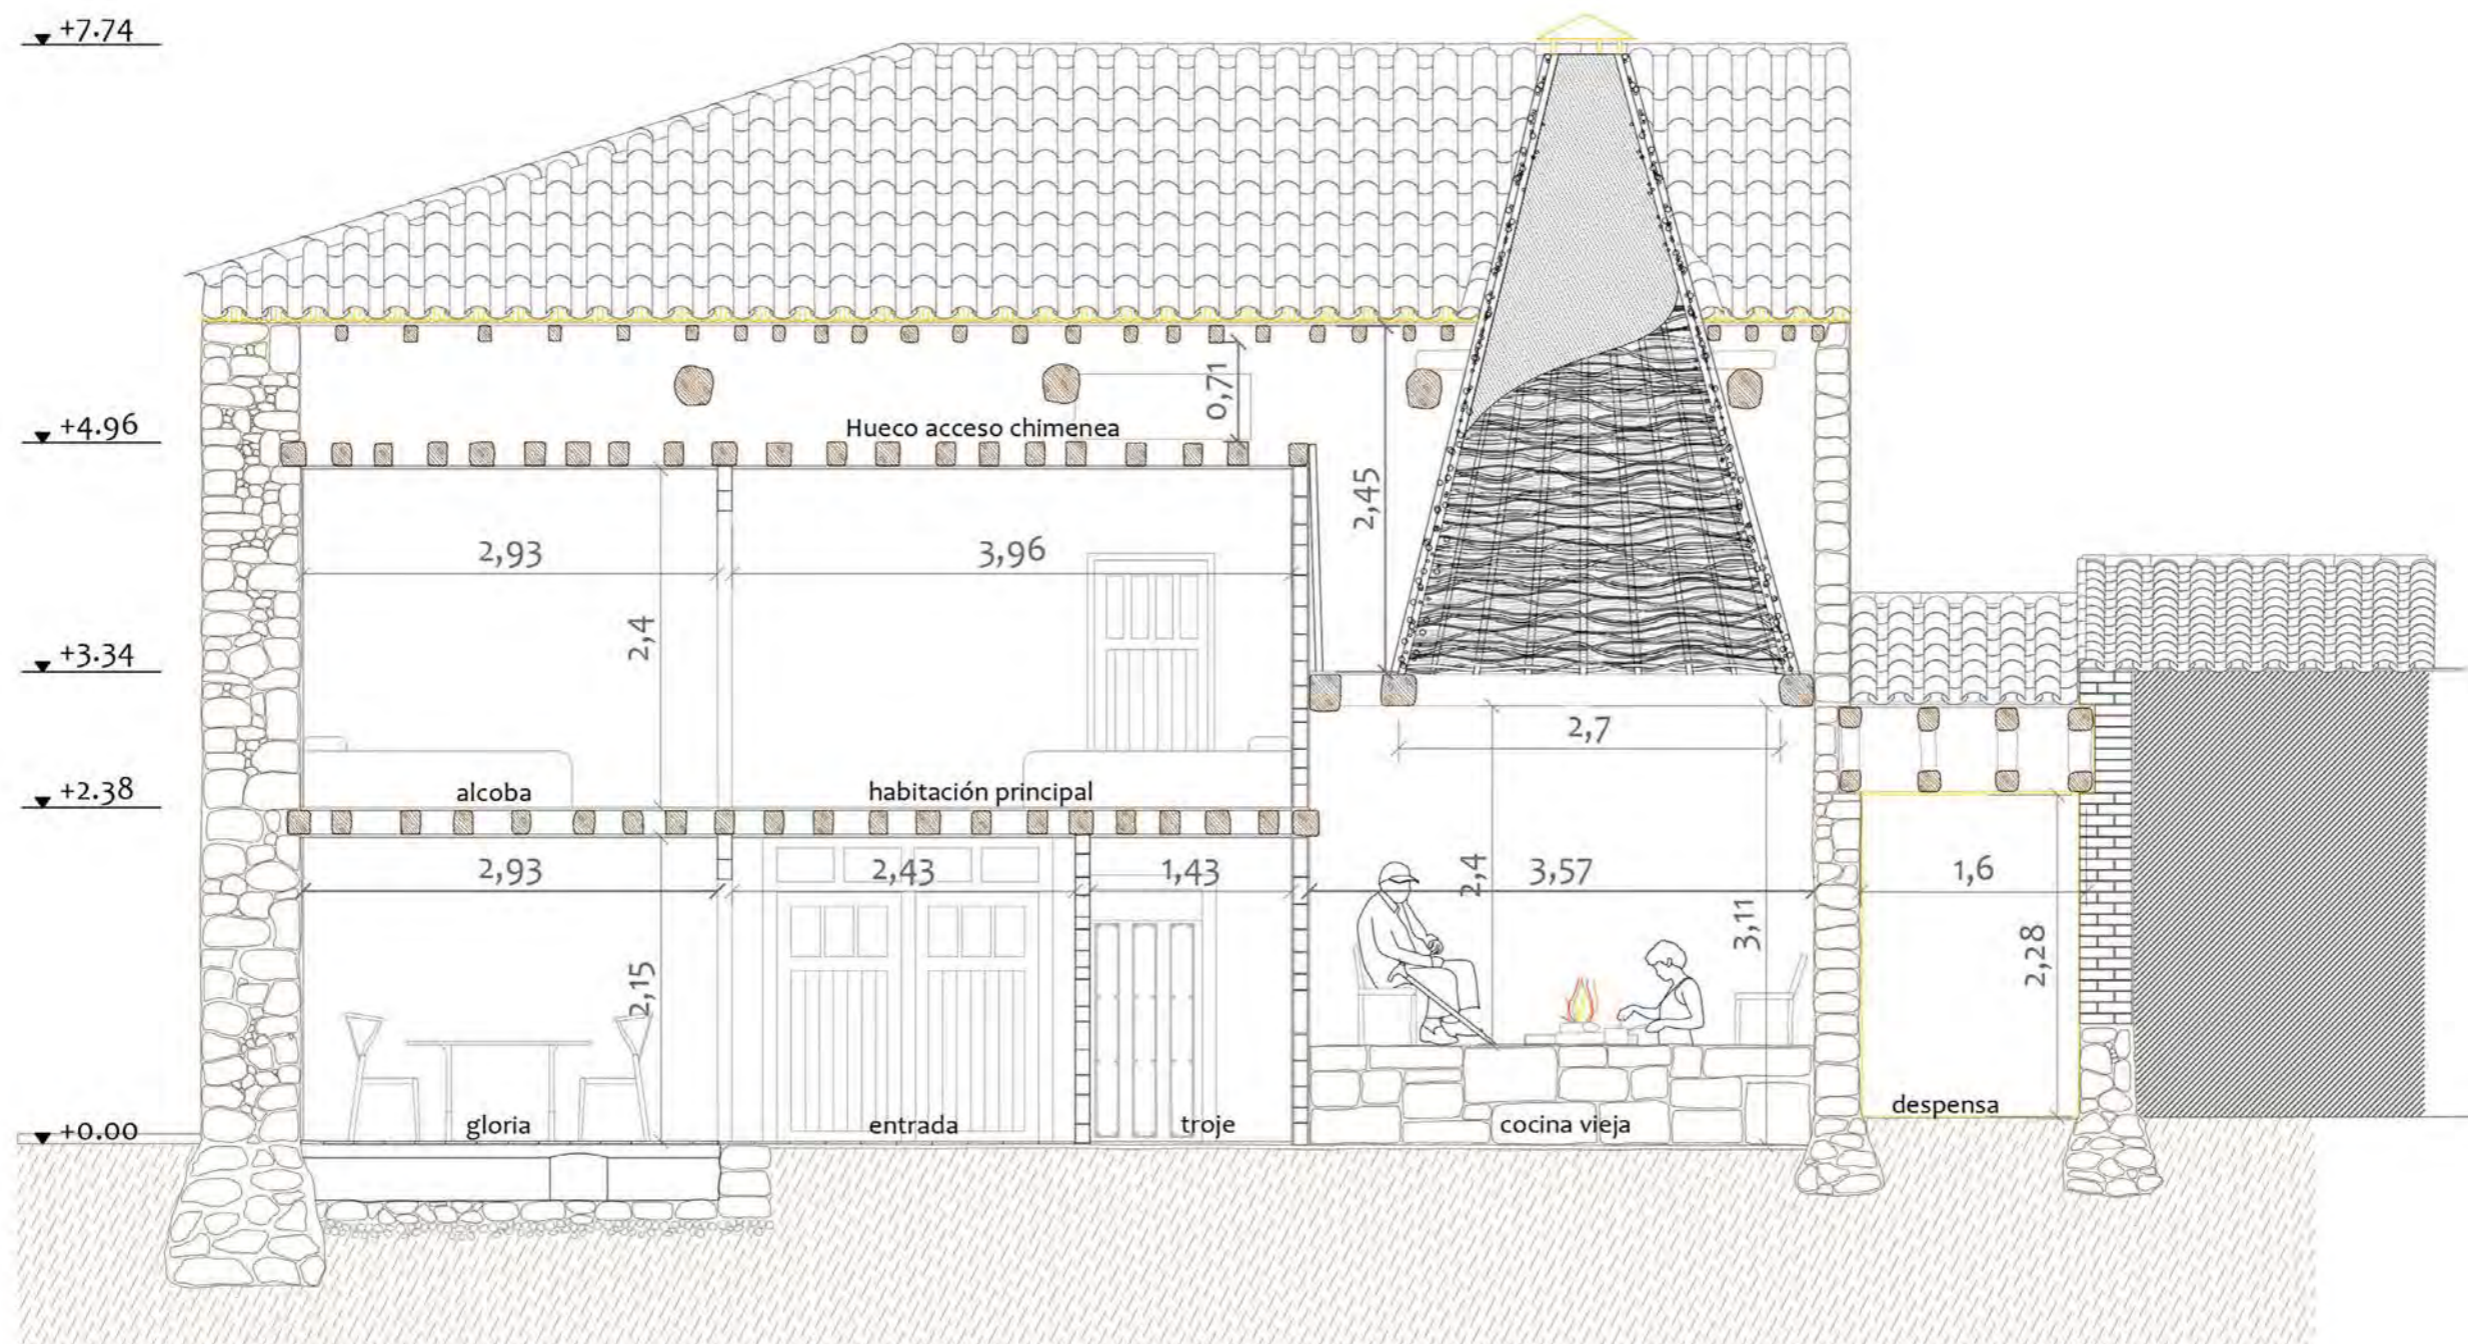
Sección constructiva vivienda casa de estudio.
